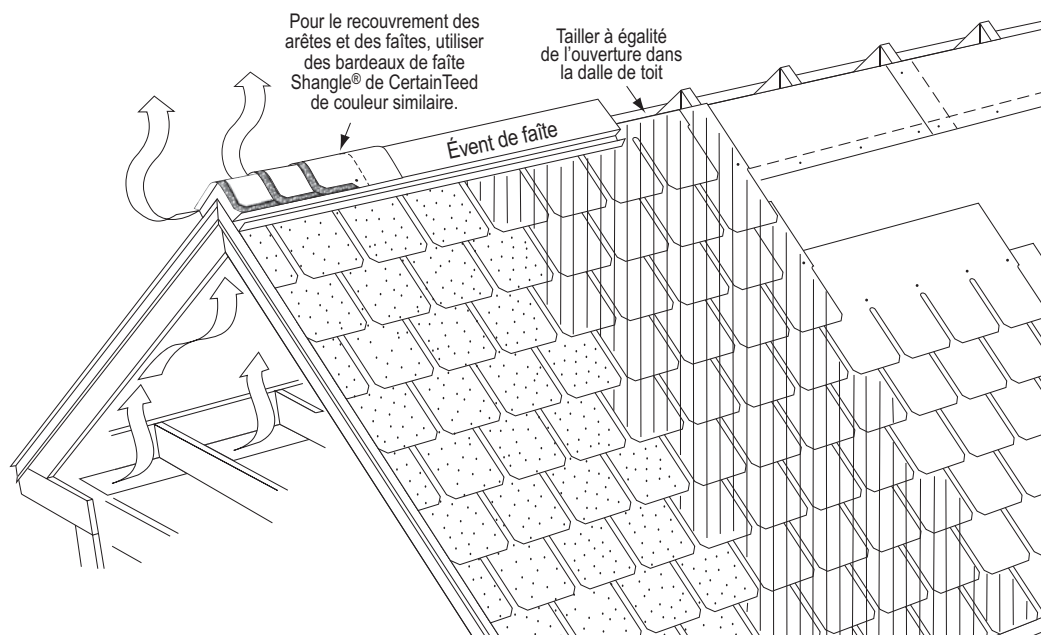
Pose de bardeaux de faîte Shangle Ridge sur un évent de faîte.
